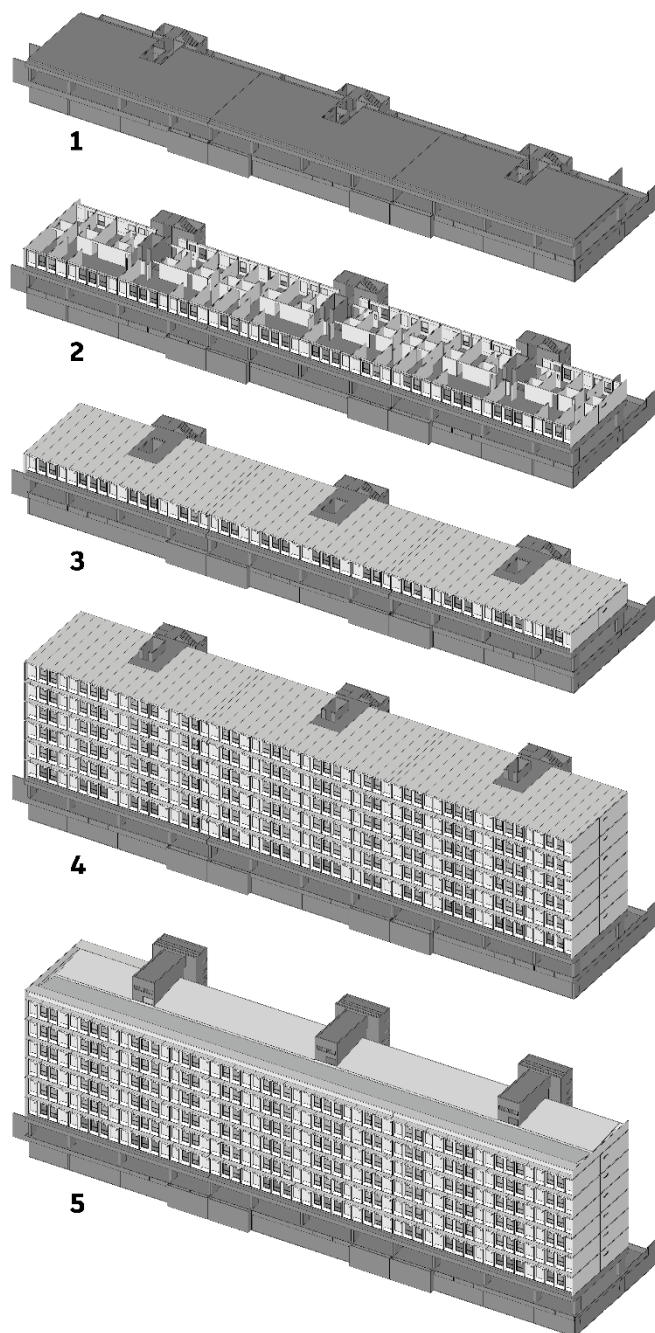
Etapas de construção do bloco R3. Fonte: da autora.
